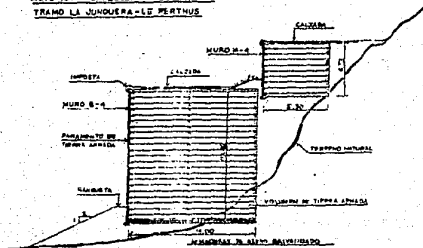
Utilización en carreteras y autopistas de montaña I..
